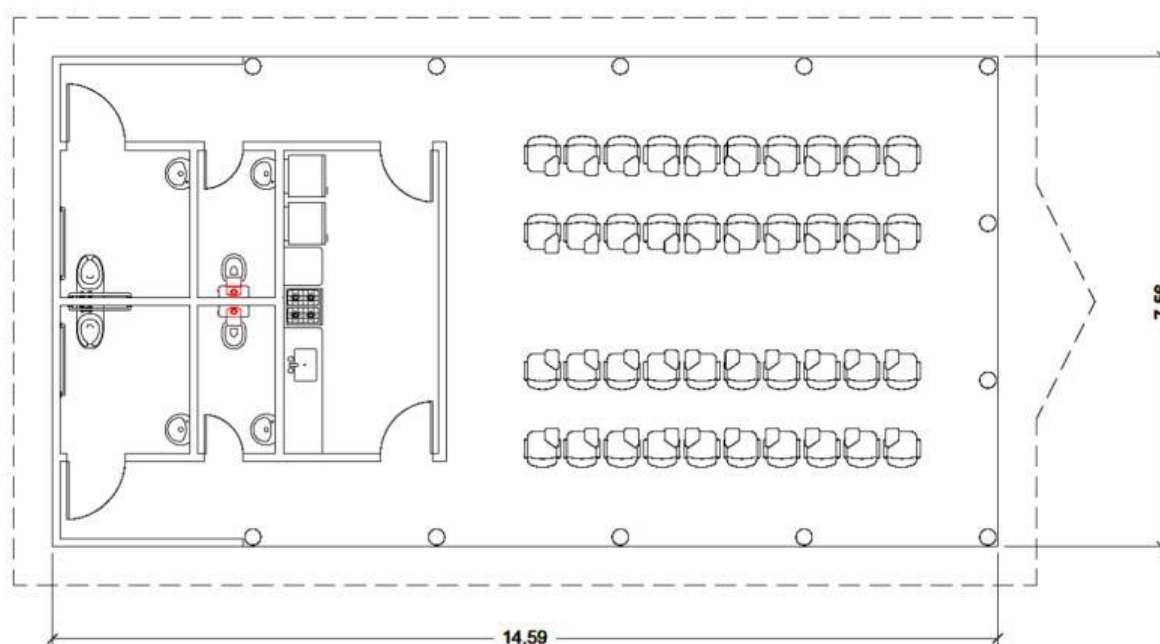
Proposta de planta-baixa para o centro de vivências na Base Maruim.
